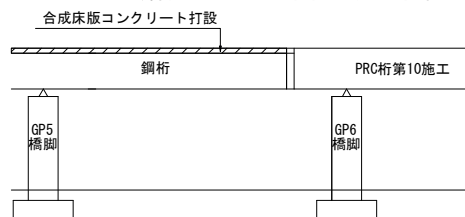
PRC 桁と鋼桁の接合部施工ステップ図
